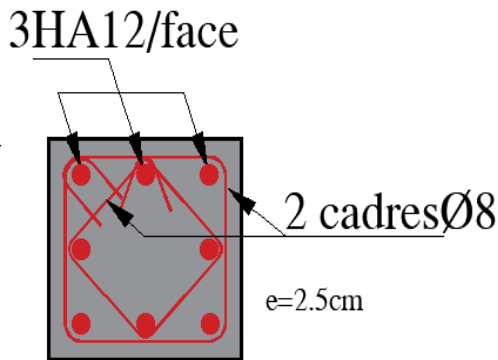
Schéma de ferrailage des poteaux du (4ème étages et la buanderie)
